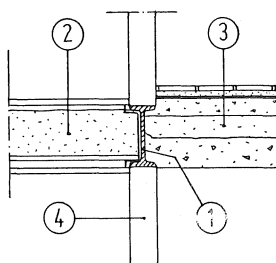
Mellanbjälklag trä/betong fram till 1940
